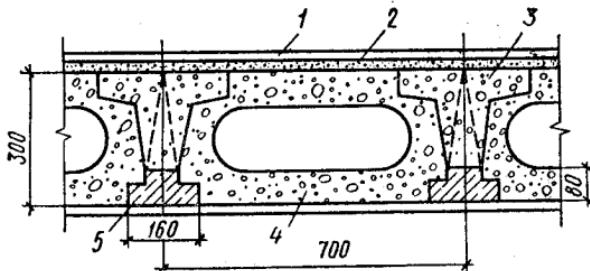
Сборно-монолитные конструкции для замены перекрытий:
